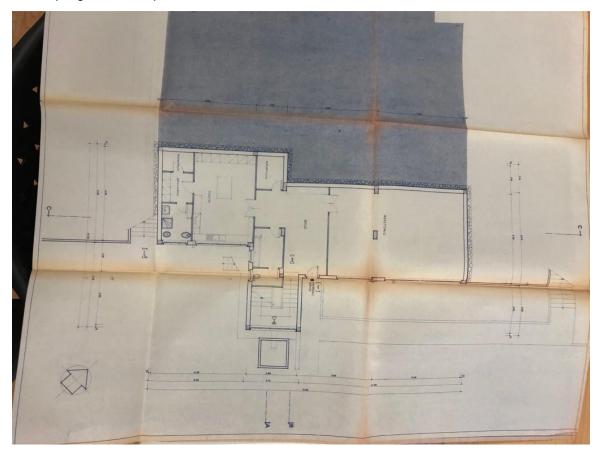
Pianta piano seminterrato (progetto architettonico – 1975)
